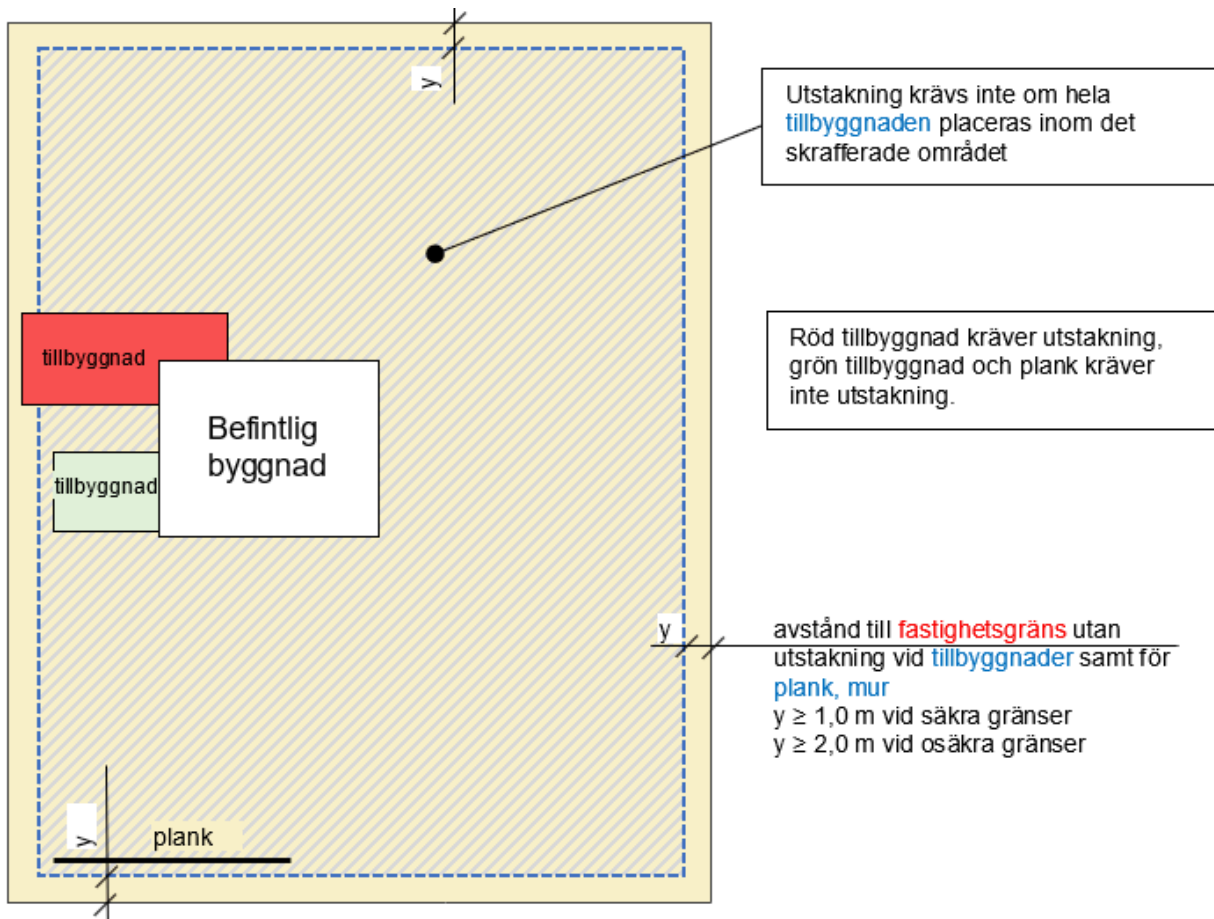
Utstakning vid placering av tillbyggnad eller plank, mur etc nära fastighetsgräns (gäller både inom och utanför planlagda områden)
